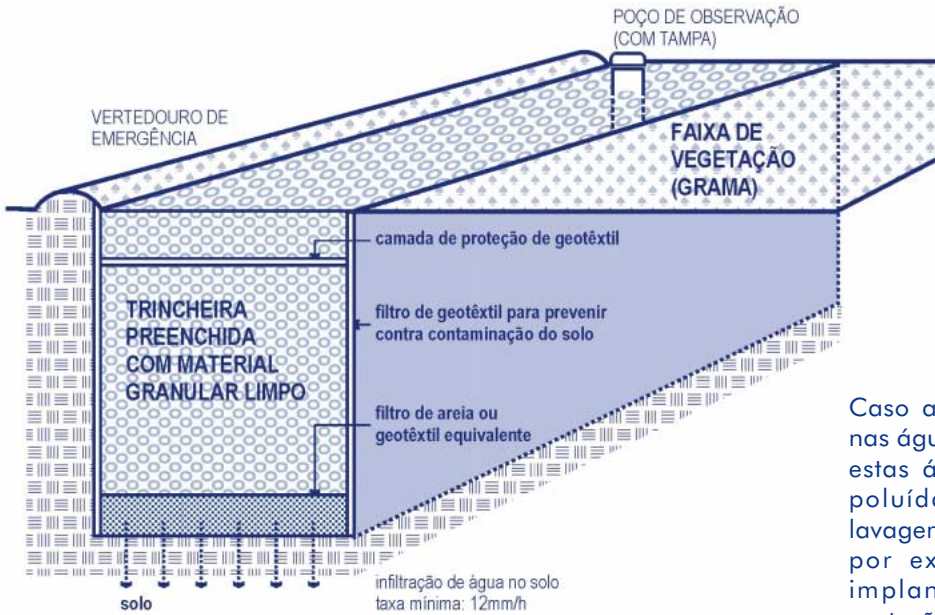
Trincheira de infiltração (Schueler, 1987)
